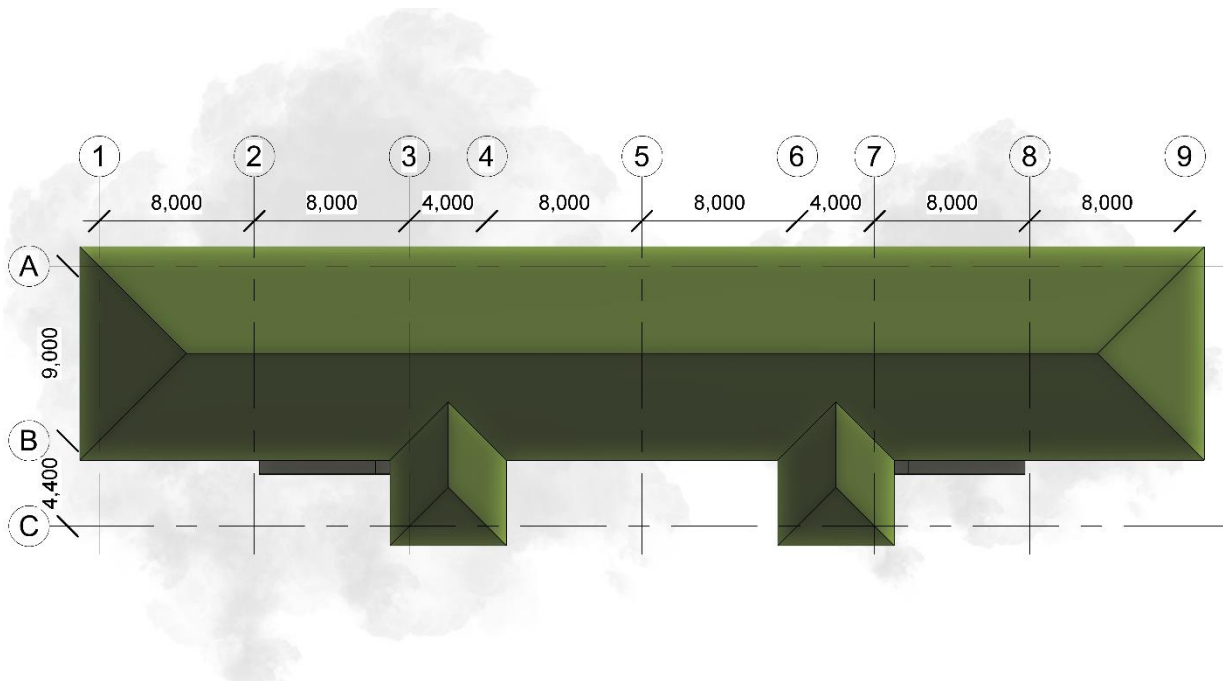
PLANTA DE TECHO EDIFICIO 3 | Elaborado por: El autor
